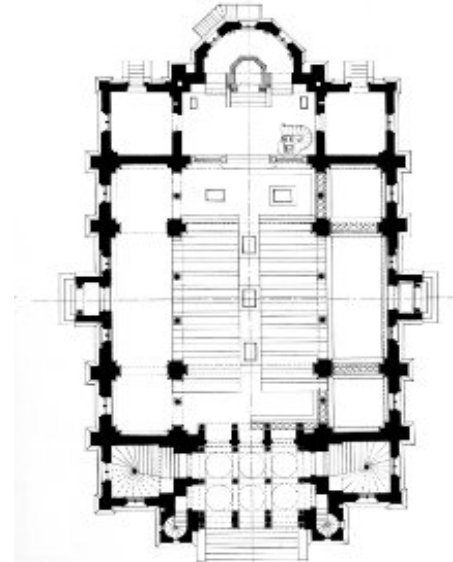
Grundriss Synagoge Stuttgart
